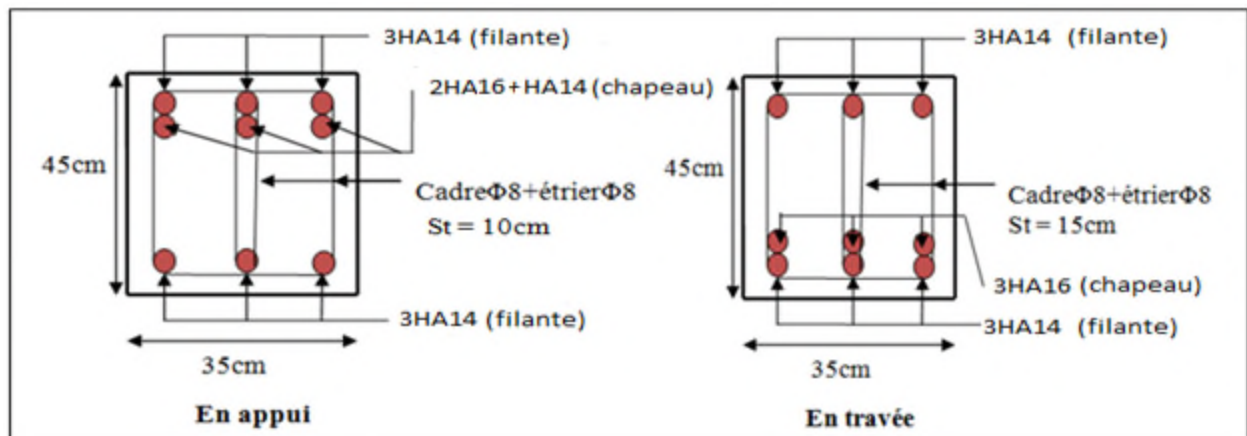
Exemple de Schéma de ferrailage d'une poutre principale.
